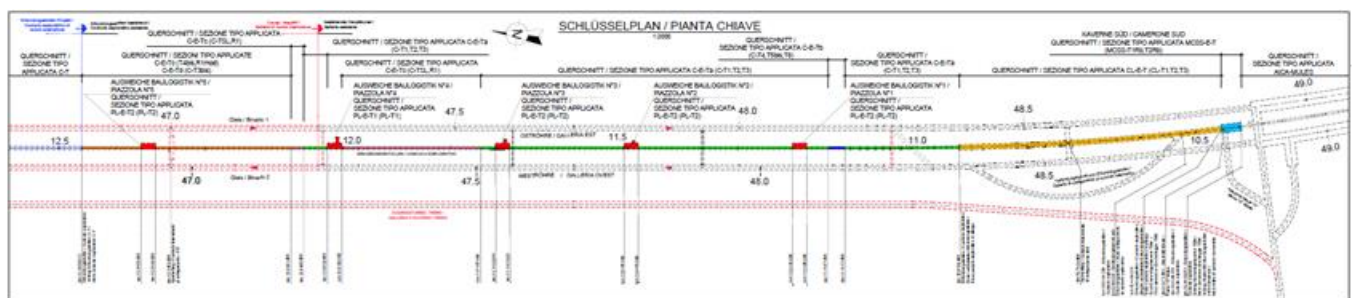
Planimetrisches Schema der bestehenden Erkundungsstollenstrecke [104].
